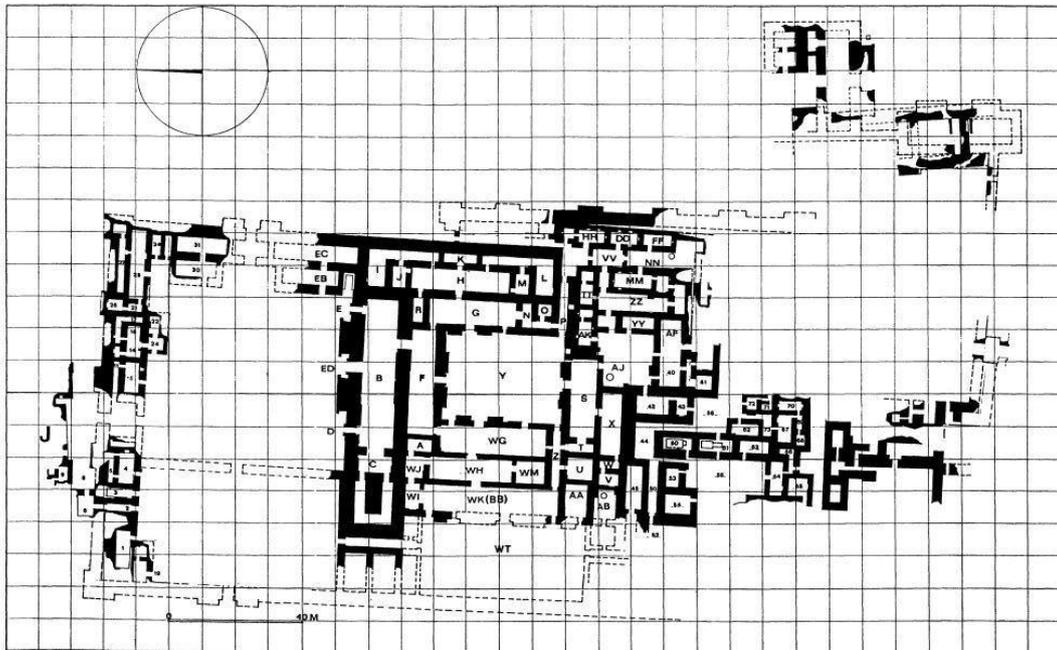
Planta geral do Palácio Noroeste de Ashurnasirpal II.
